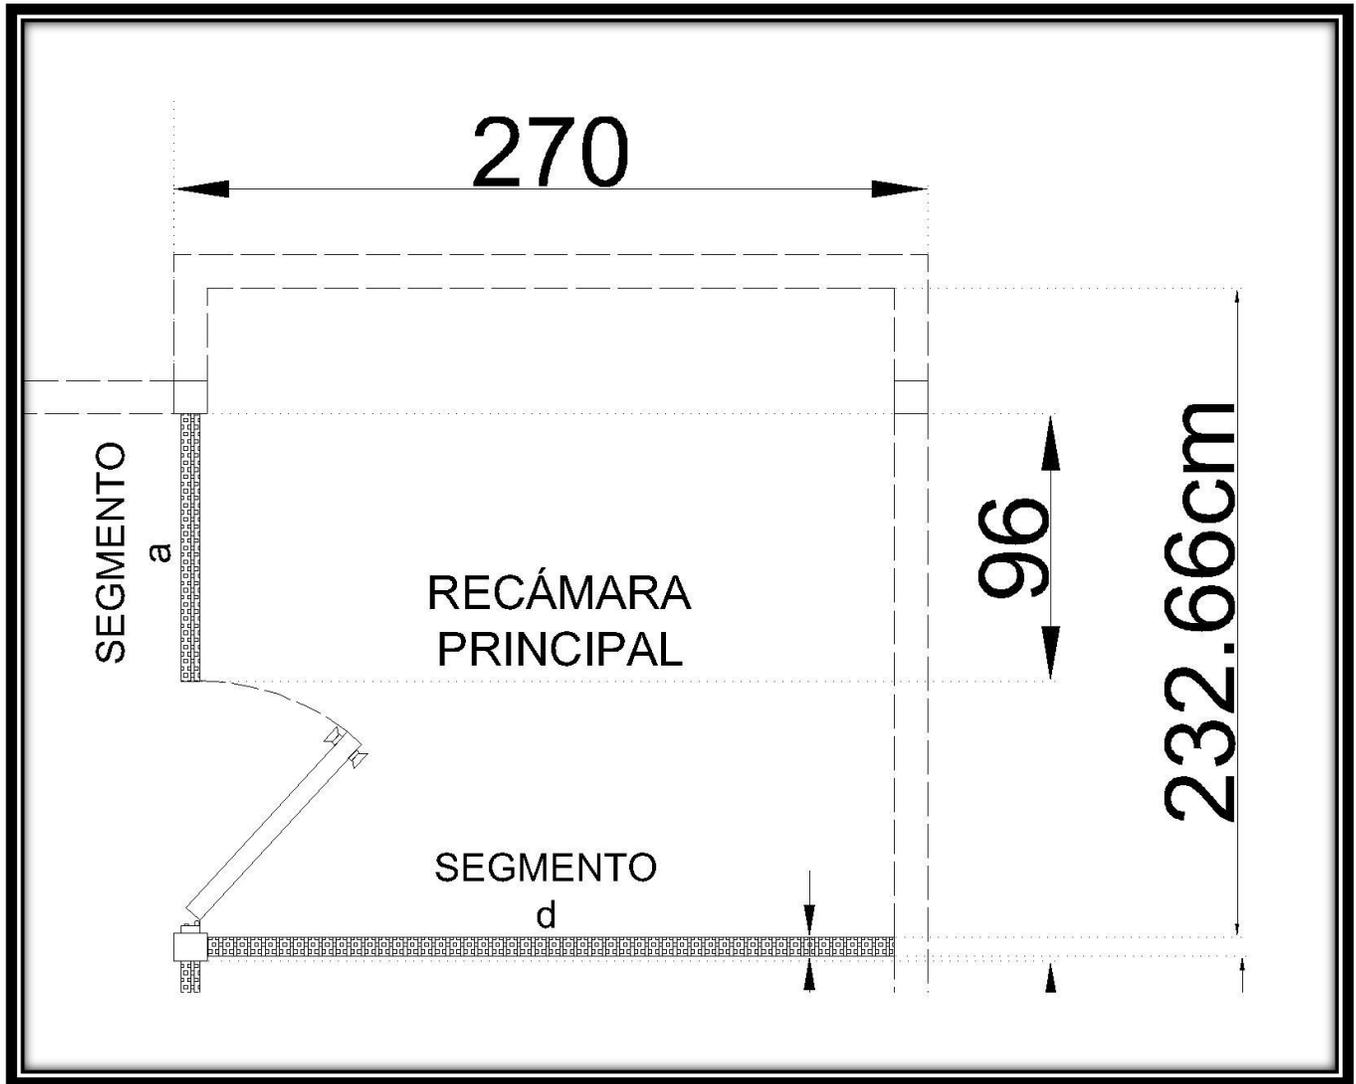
Muros con Paneles de Yeso. Detalle Recámara principal.
